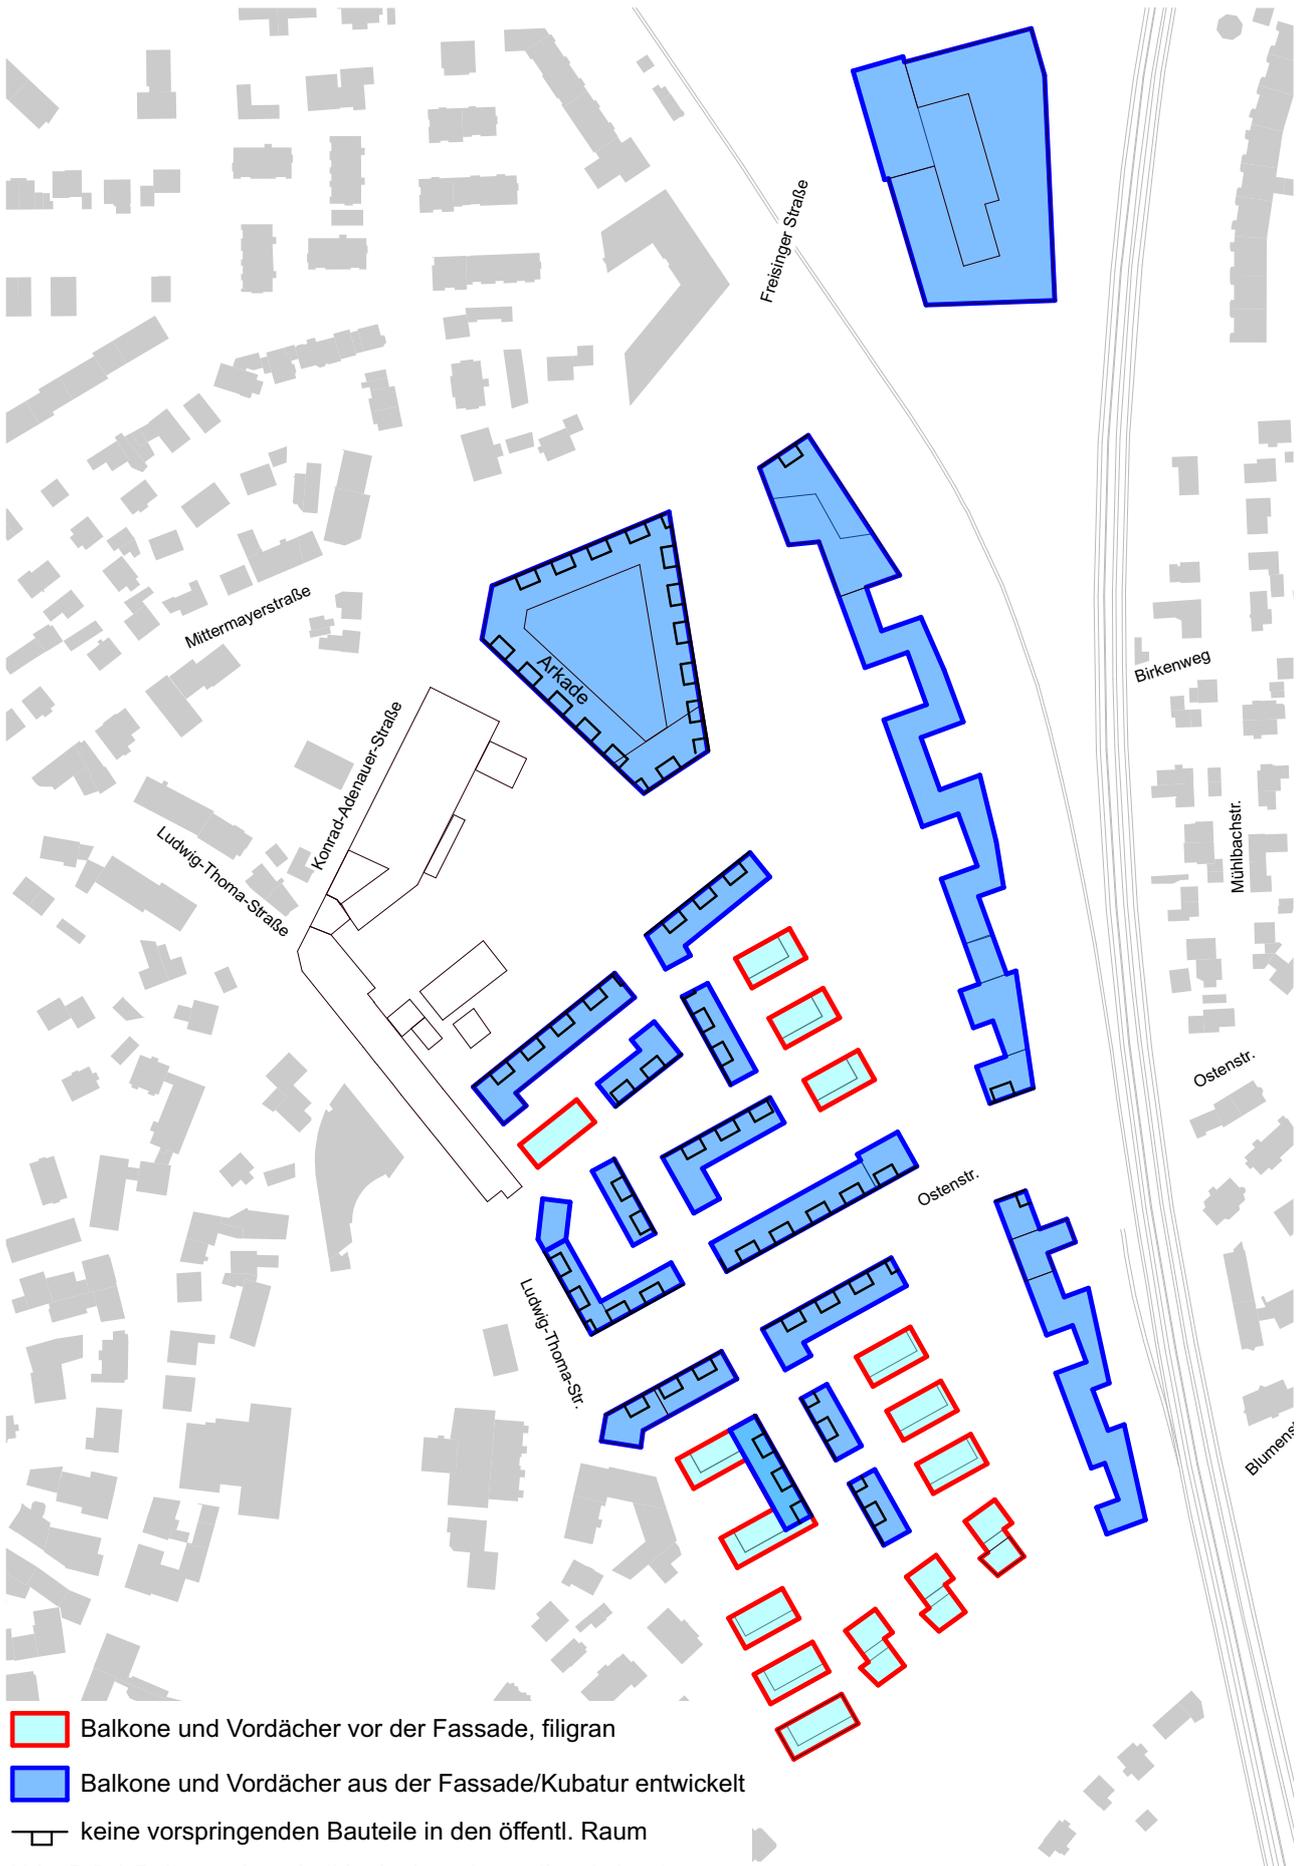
Balkone, Loggia, Vordach und sonstige Anbauten
